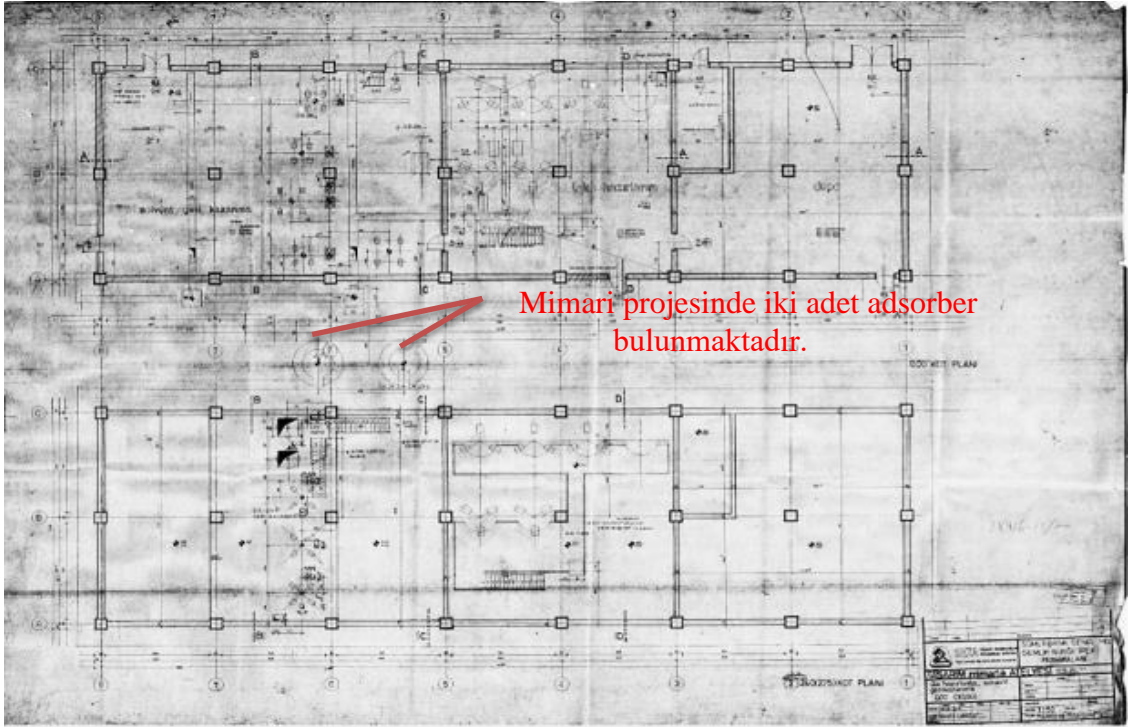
11 Şubat 1977 yılına ait genel vaziyet planı (Anonim 1977)
